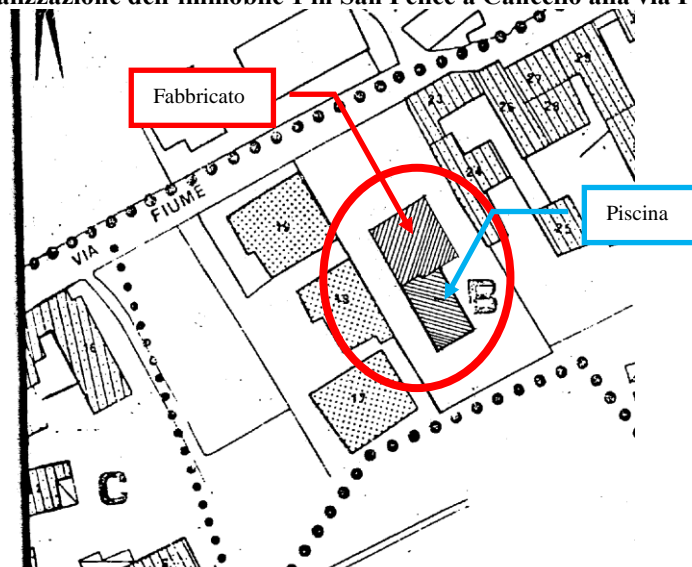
Stralcio del Piano di Recupero in cui ricade il lotto dell'immobile 1 – fabbricato + piscina
